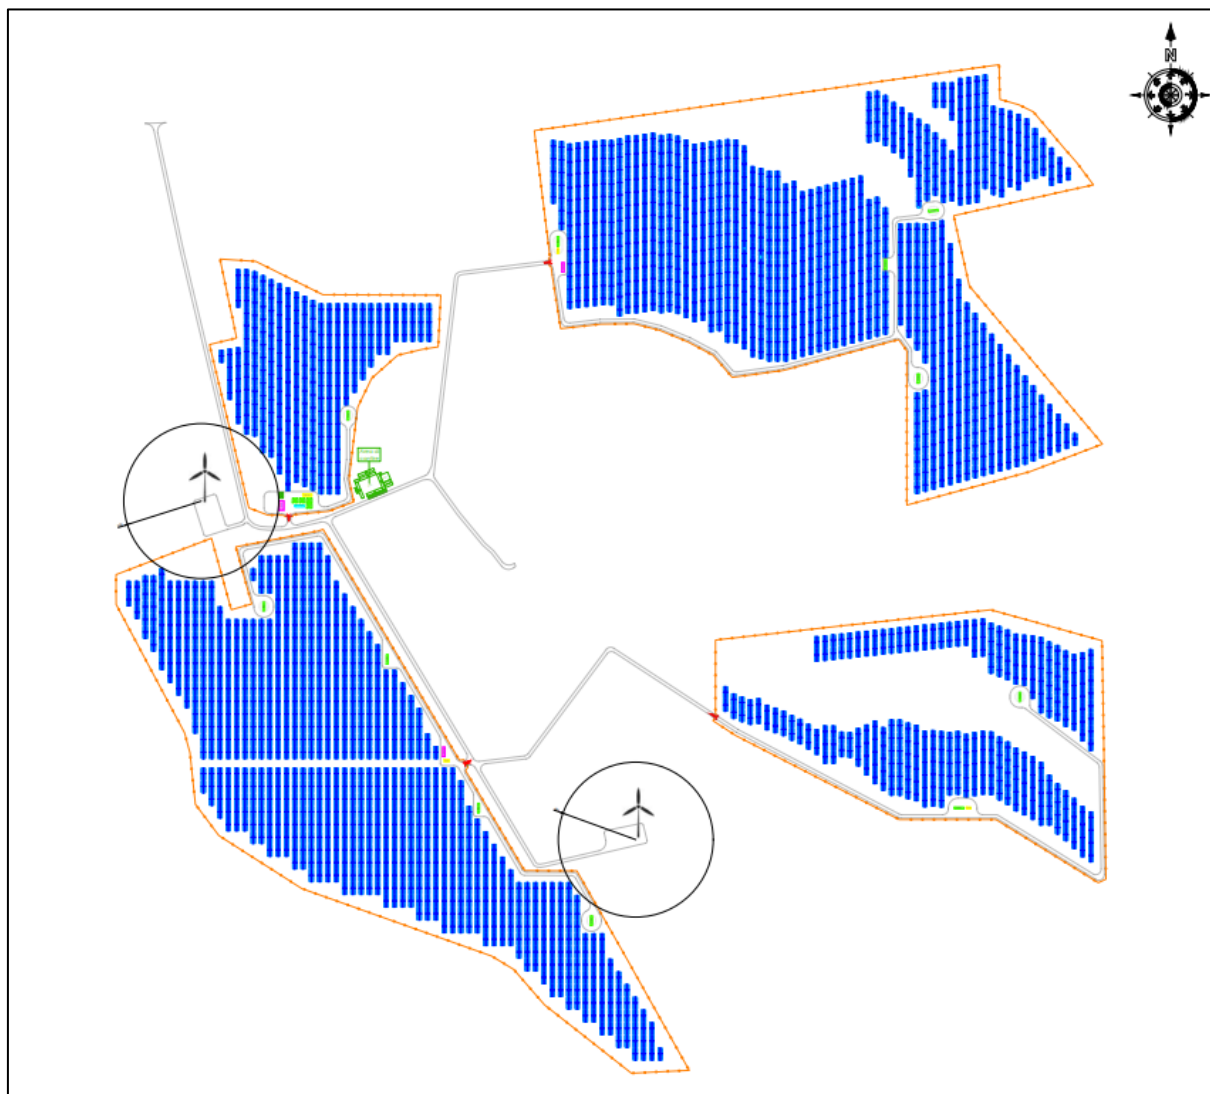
Layout dell'impianto agrivoltaico con evidenza della distanza dalle pale pari alla gittata massima
